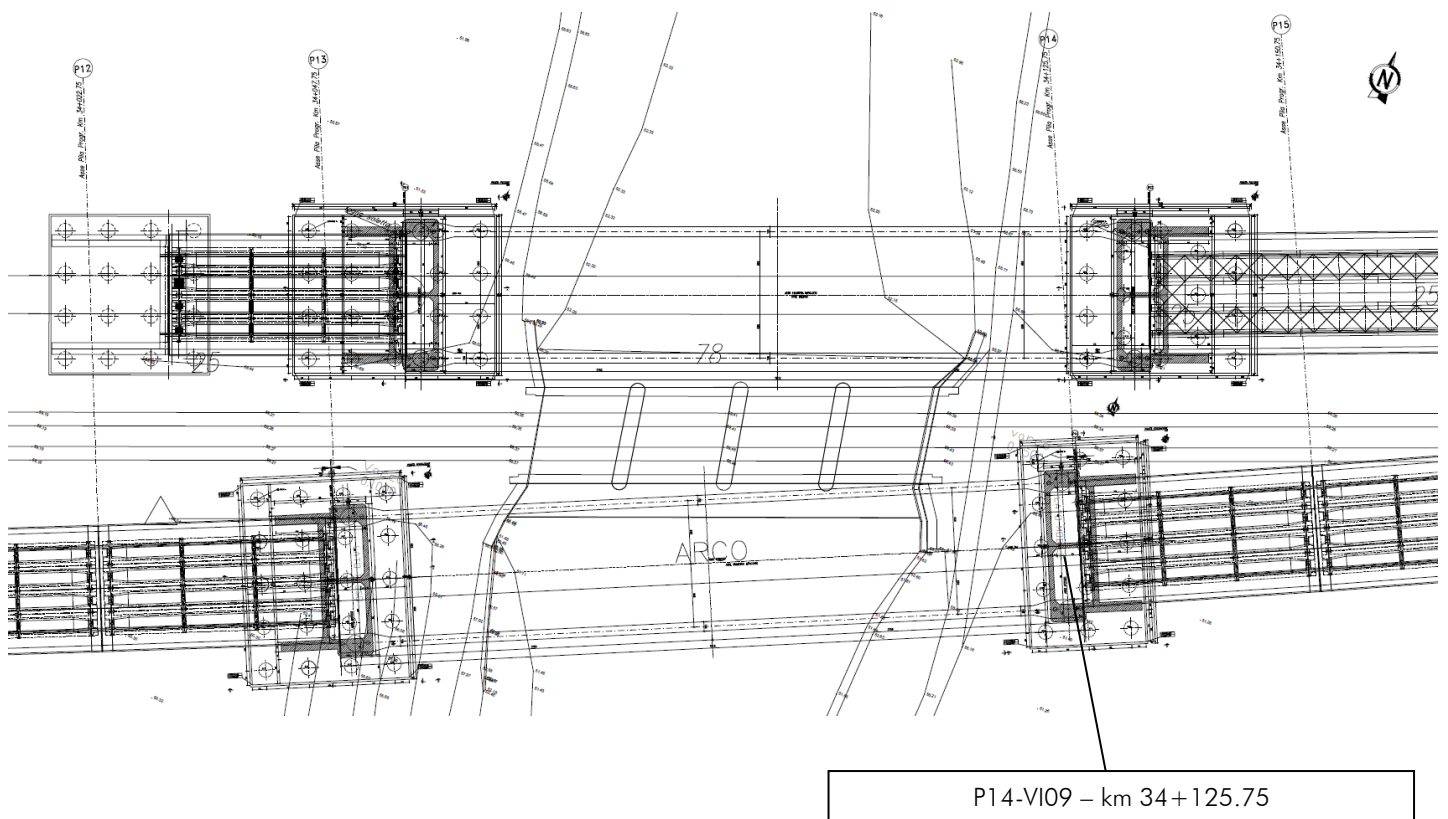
Stralcio planimetrico – Ubicazione Pila P14 Viadotto VI09
